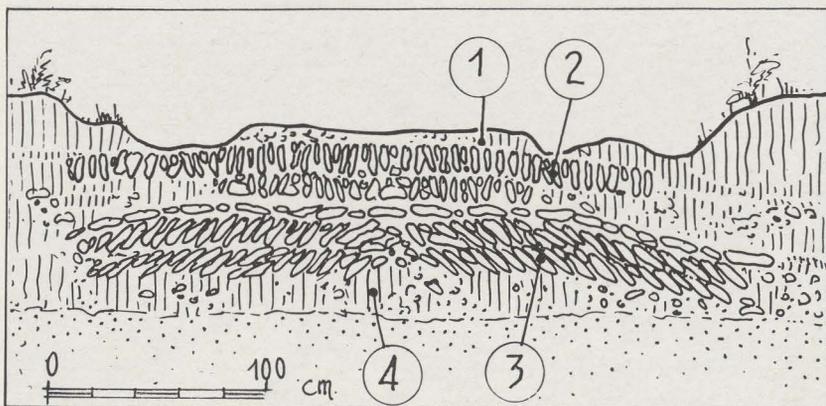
Coupe dans la Bavai-Trèves (n° 3) à Sibret.
